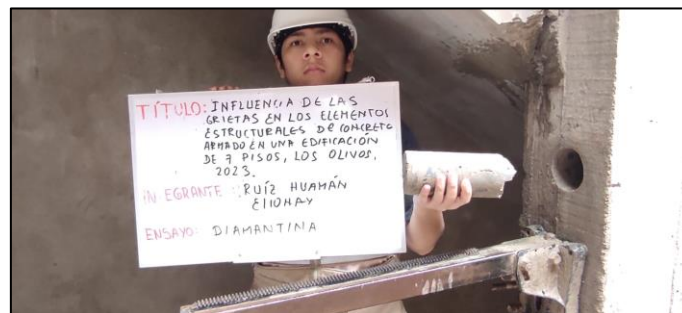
Culminación del ensayo para después llevar la porción de concreto a laboratorio.
